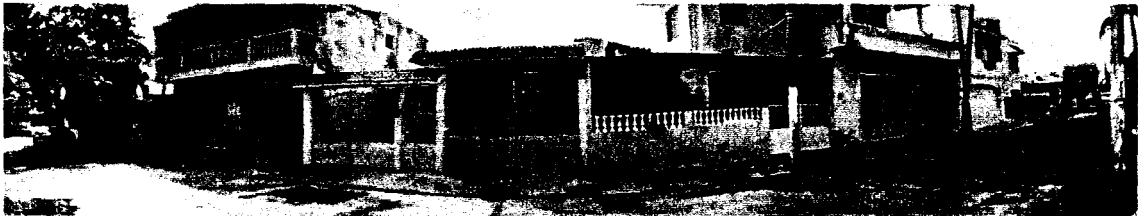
Vista Frontal desde la calle Educación.
